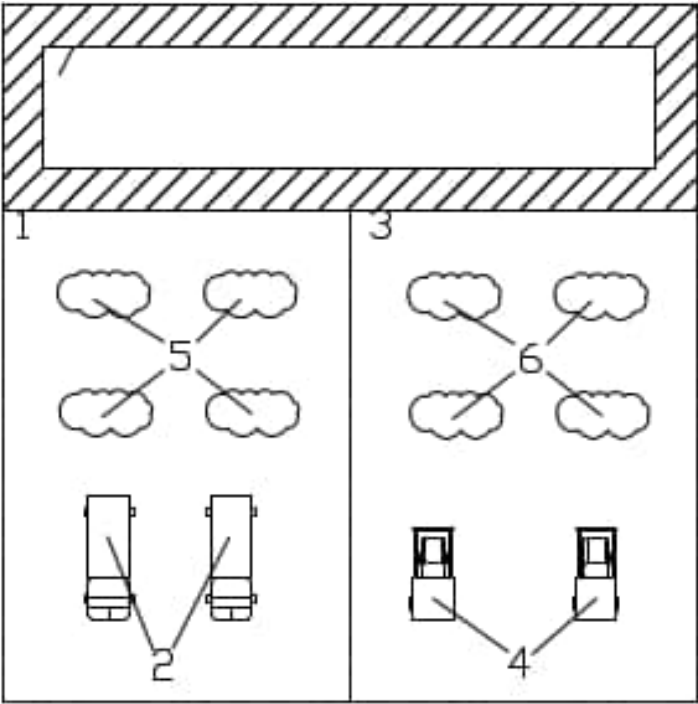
Технология разгрузки самосвалов и работы бульдозеров по сдвиганию грунтов на рабочую карту: 1 – участок разгрузки самосвалов; 2 – самосвалы; 3 – участок сдвигания грунта бульдозерами; 4 – бульдозеры; 5 – грунт выгруженный; 6 – грунты, сдвигаемые бульдозерами на рабочую карту; 7 – рабочая карта
